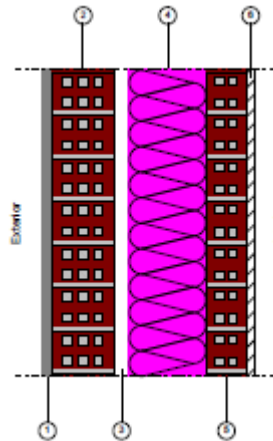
Detalle constructivo de los componentes de la fachada tras la mejora.
